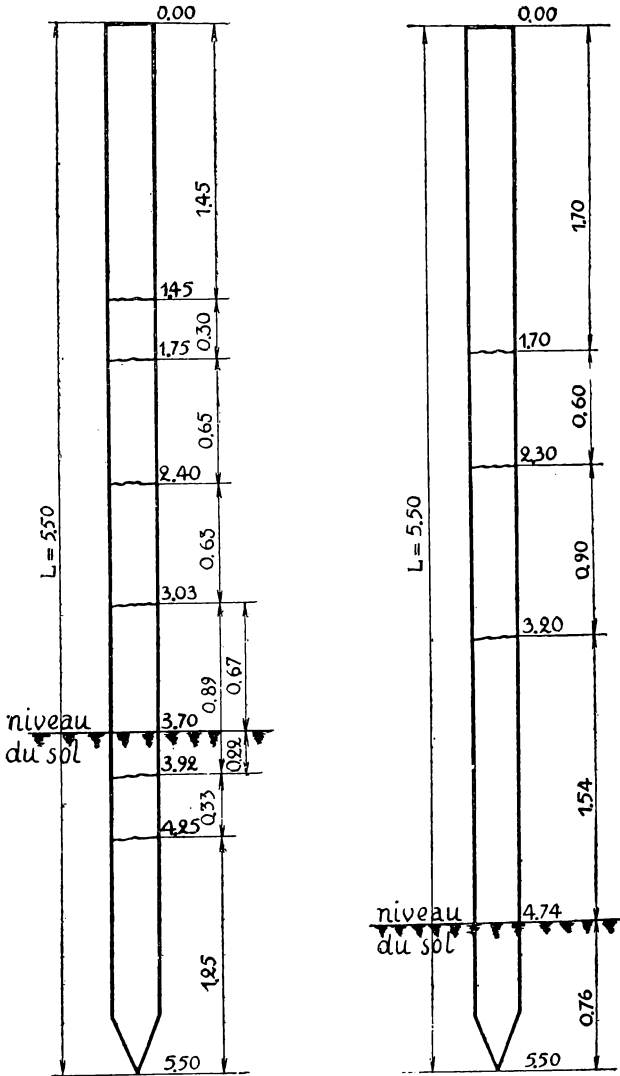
Schéma de la fissuration des deux premiers pieux battus.
